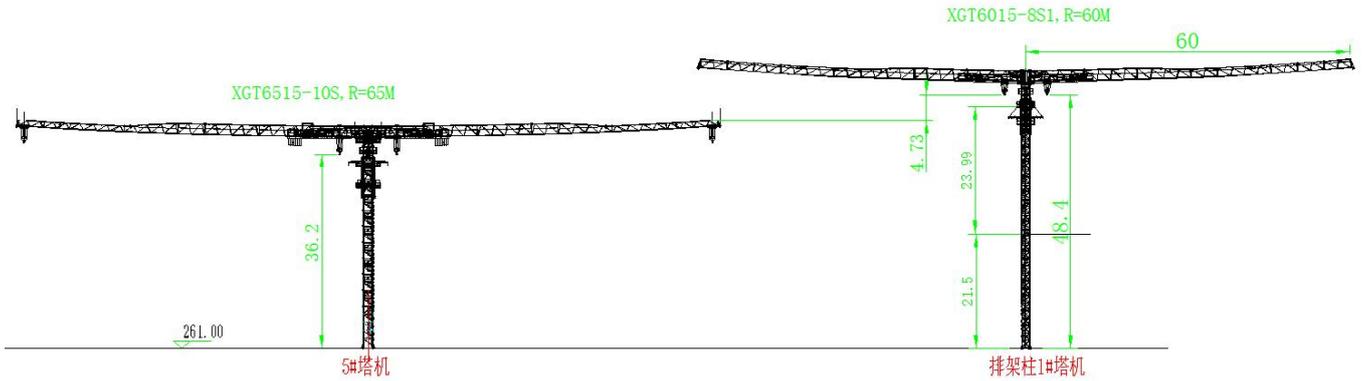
：发电厂上游 5#、排架柱 1#塔式起重机立面布置图
